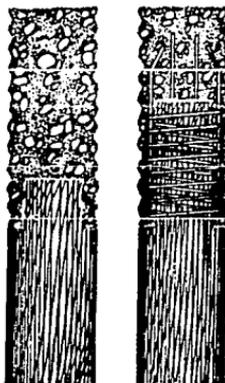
PILOTES DE MADERA COMPUESTOS
